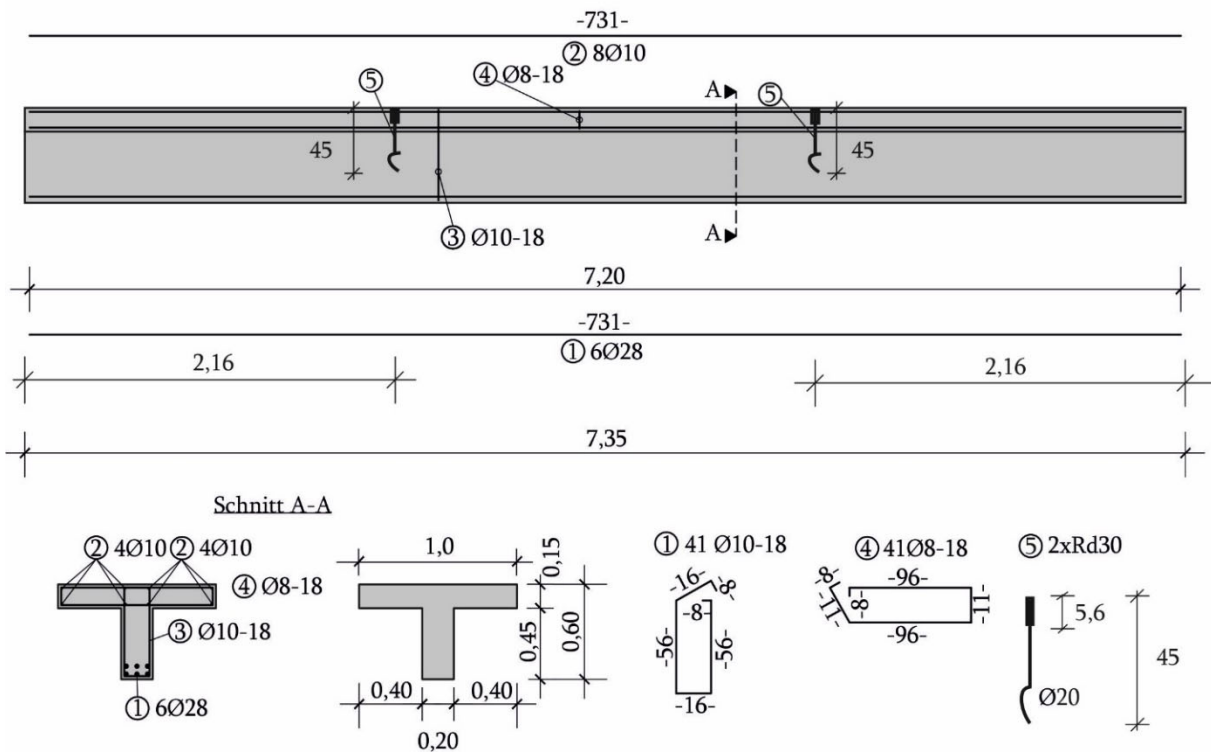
Schal- und Bewehrungsplan der Balken B3 – B5 (Balkentyps II)
